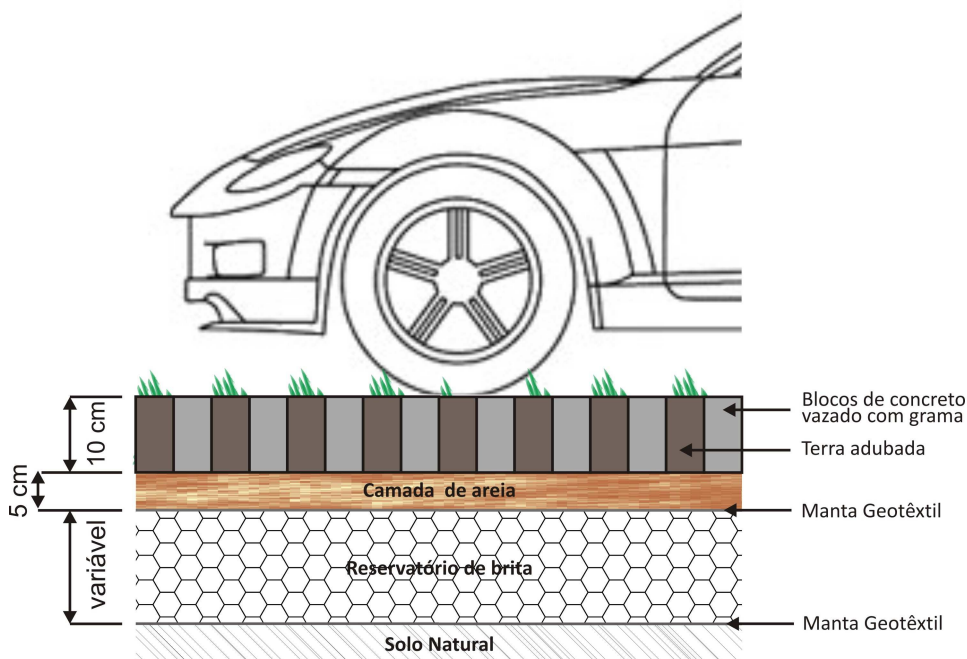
Estrutura do pavimento permeável dos estacionamentos.
